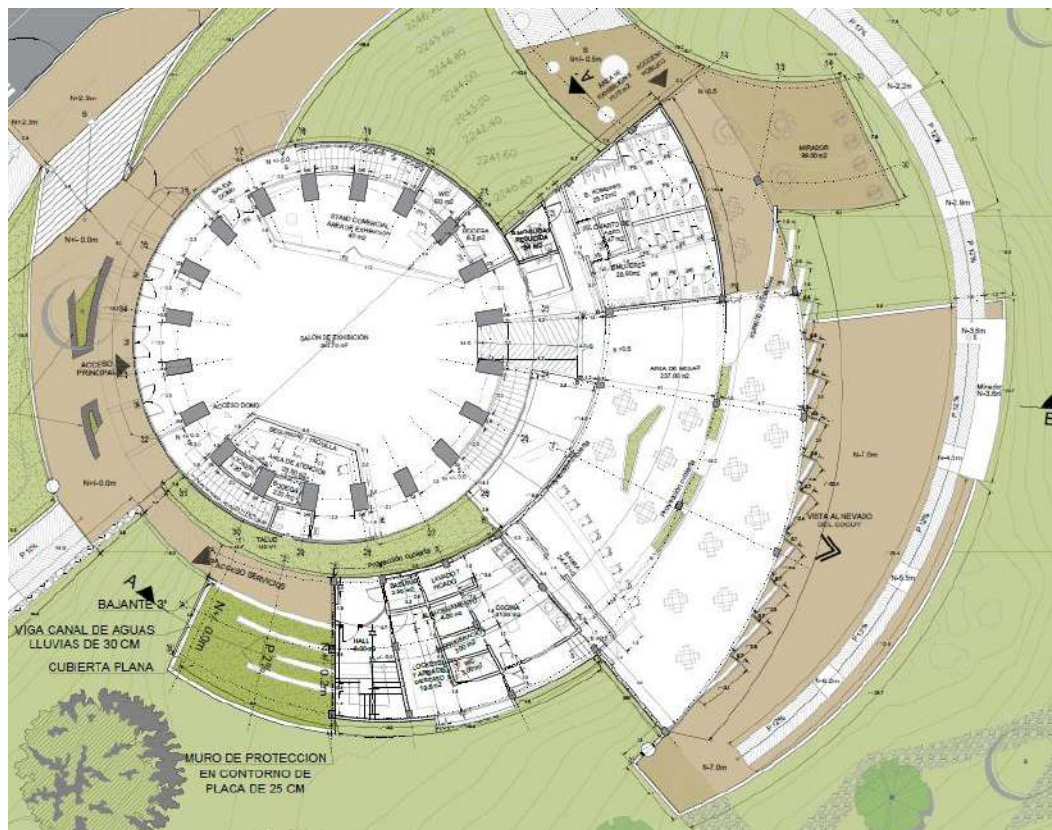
Planta ubicación general nivel -3.5m edificio Sur
